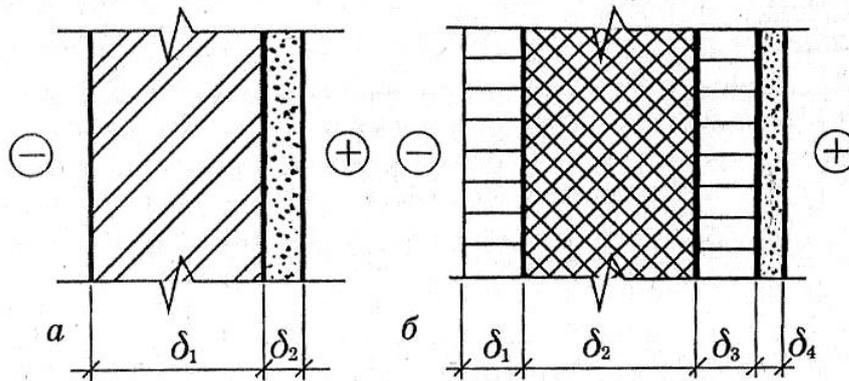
Схемы к расчету теплопроводности наружной стены:
